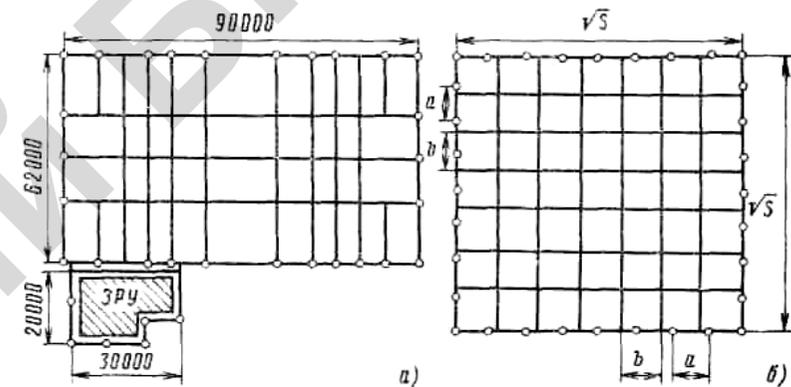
Расчет сложного заземлителя в двухслойном грунте: а – предварительная схема заземлителя; б – расчетная модель
